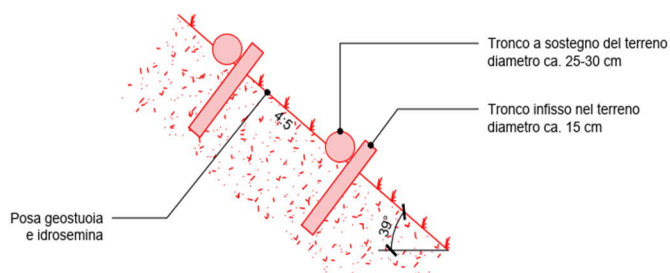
Dettaglio sostegno scarpata estratto dal piano "02 – Piano dell'intervento"
